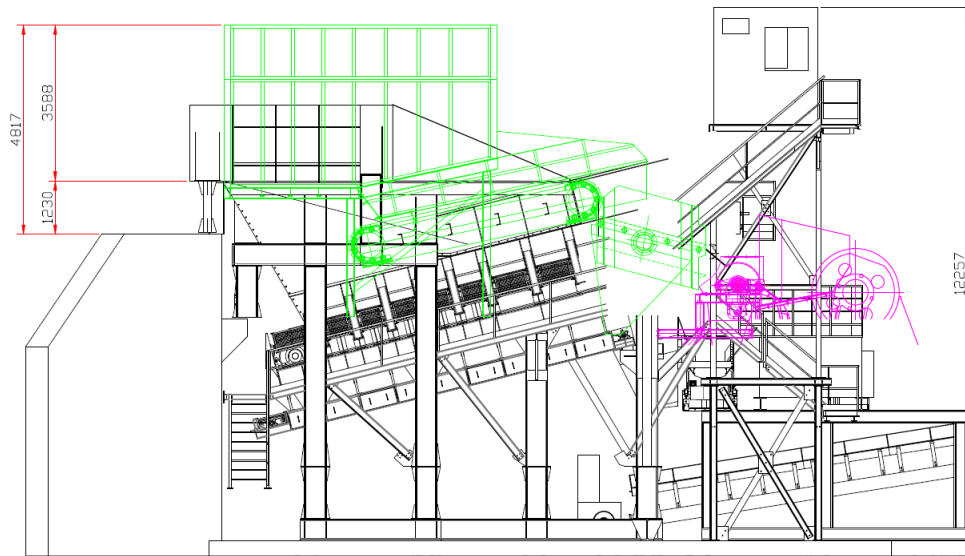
Esquema de alzado de la planta de tratamiento de materiales Fuente: Eiffage Infraestructuras SAU.
